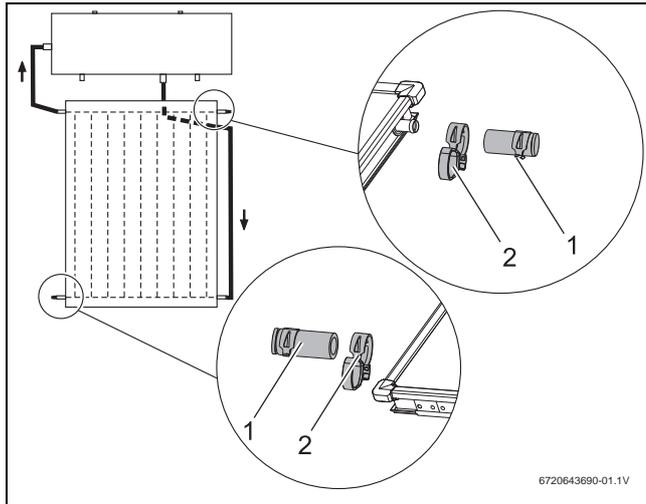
Abraçadeira de mola com anel de retenção e tampão cego pré-montado.
